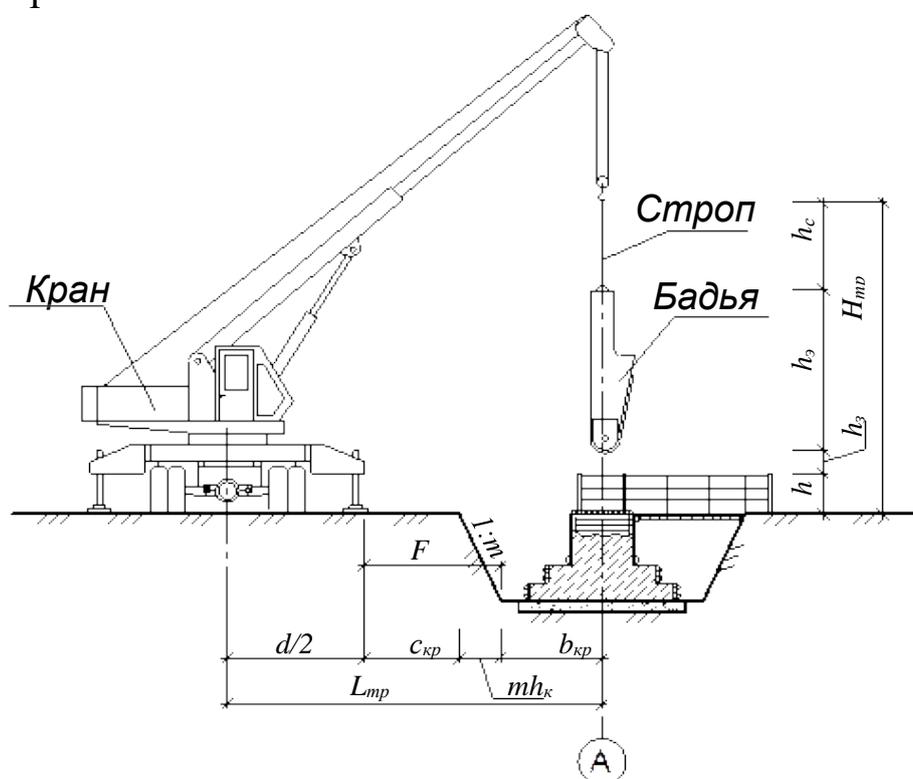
Схема к определению $H_{\text{тр}}$ и $L_{\text{тр}}$ при бетонировании монолитных фундаментов (при расположении крана на бровке котлована)
